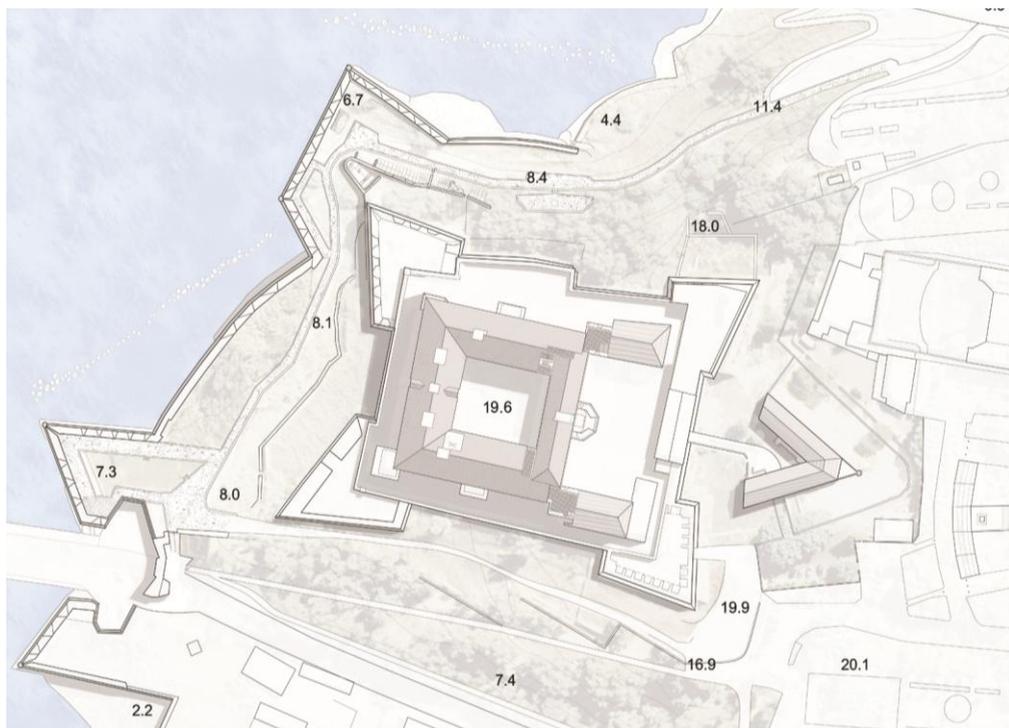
Rilievo planimetrico delle opere fortificate oggetto di studio
